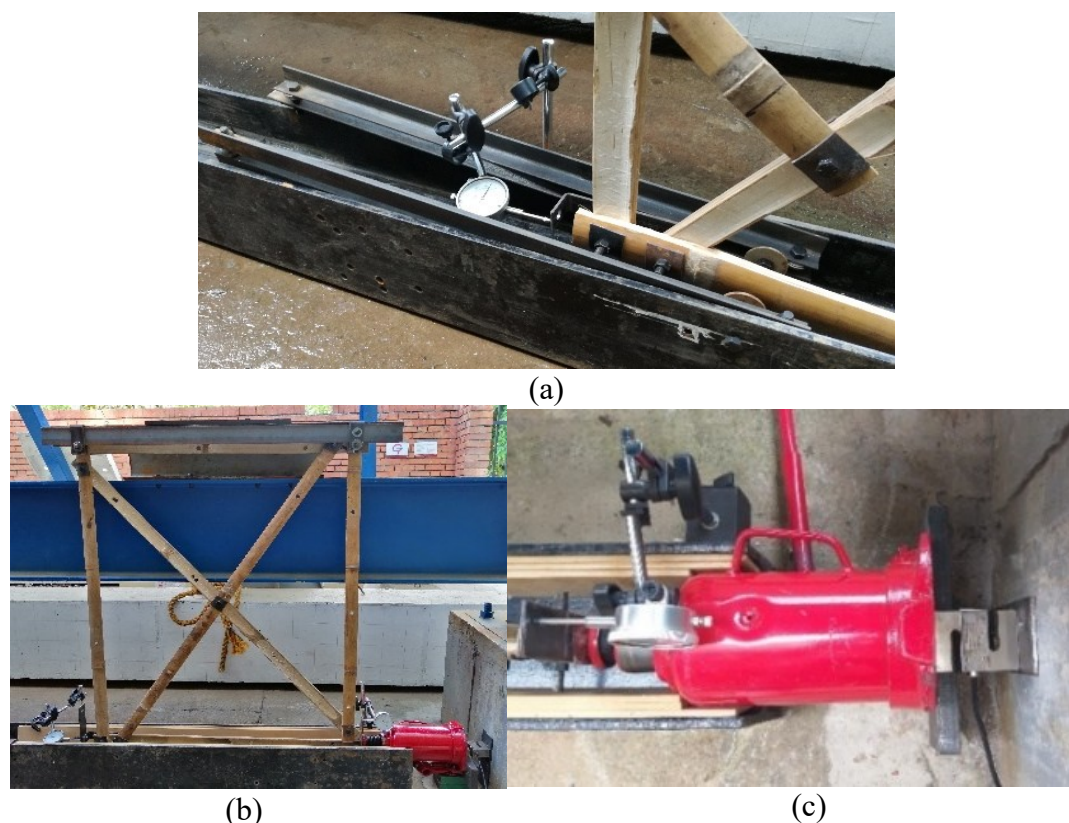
(a) Ejes guía de desplazamiento, (b) Montaje experimental y (c) Montaje Gato-Celda.
